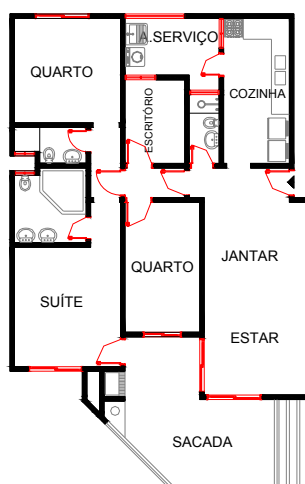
Planta Baixa do apartamento 602 - Estudo de caso E.
